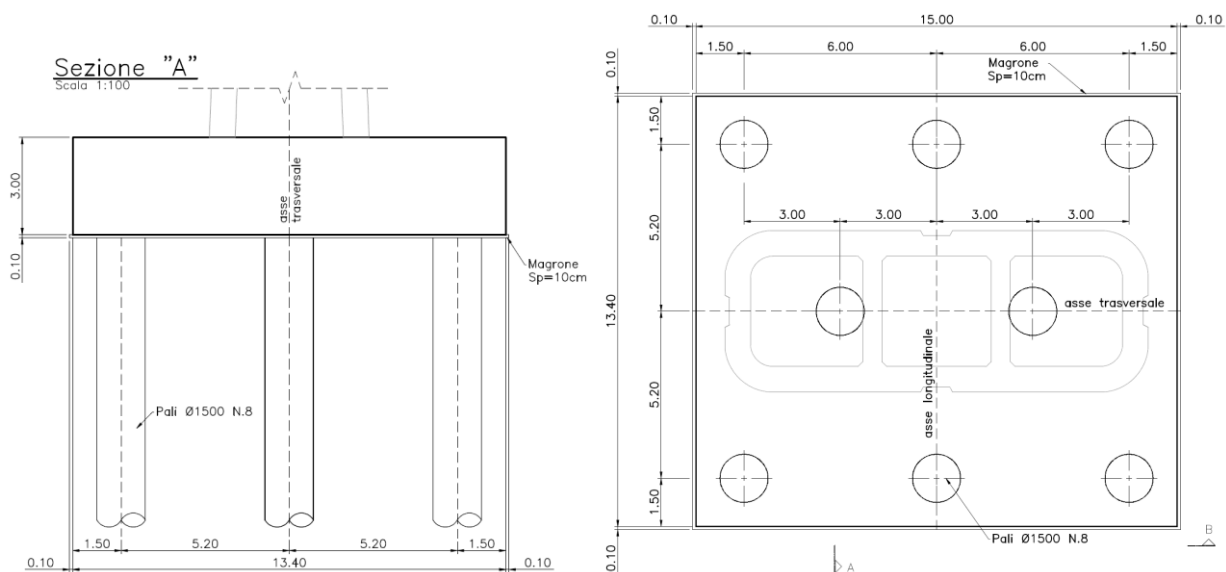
stralcio della carpenteria pila e fondazione su n° 8 pali
